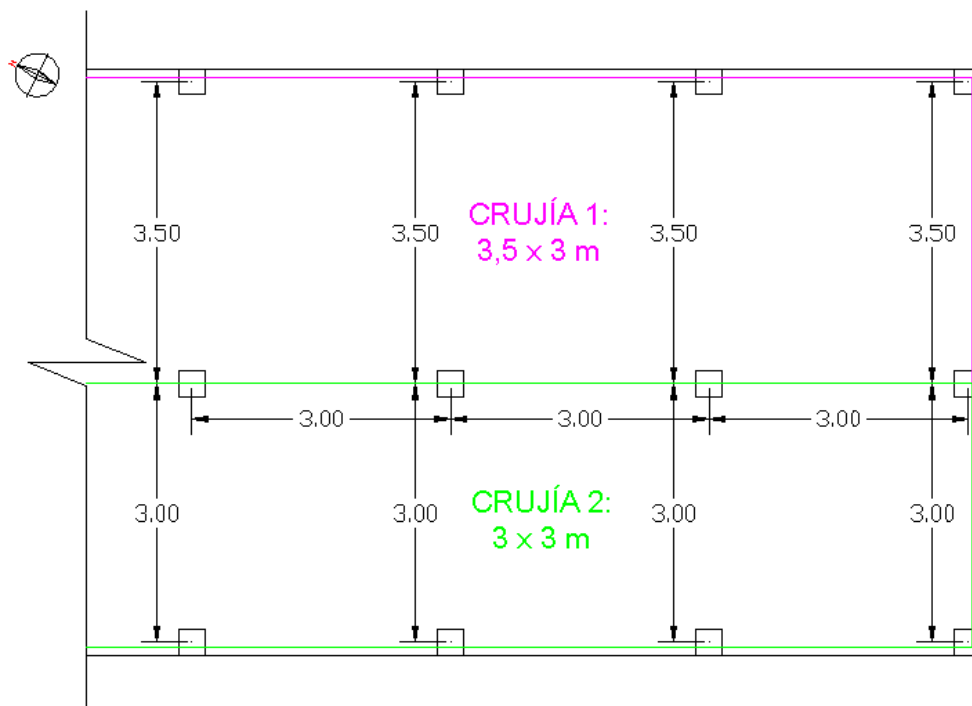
Planta esquemática de la distribución de pilares en el ala de baños.
